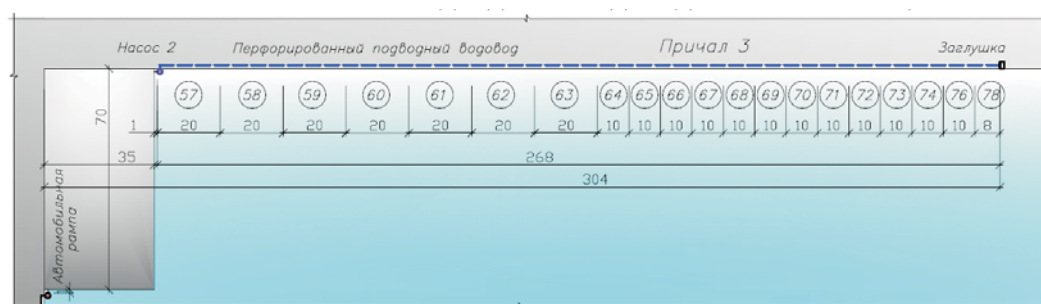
Схема перфорированного трубопровода насосной установки для причала № 3 МПТ «Морской фасад» (в кружках указан размер отверстия для соответствующего участка трубопровода)
